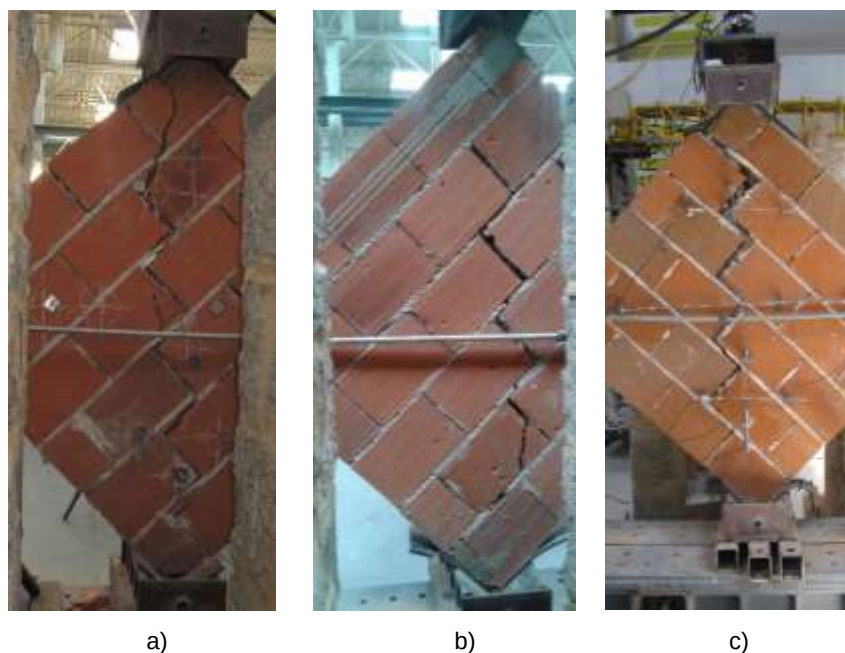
Rotura dos Muretes CD15 por deslizamento; a) Provete A; b) Provete B(3); c) Provete C(2)
